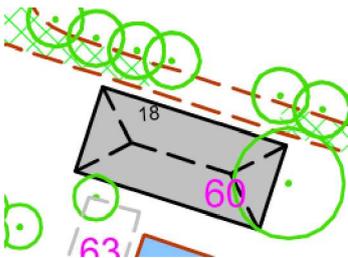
Lageplan der zu bewertenden Gebäude 1.BA
